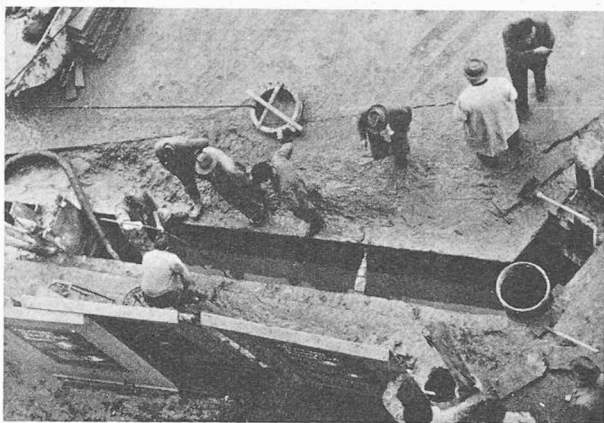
Paroi en fouille constituant l'enceinte d'une excavation pour passage sous chaussée à Lucerne.
